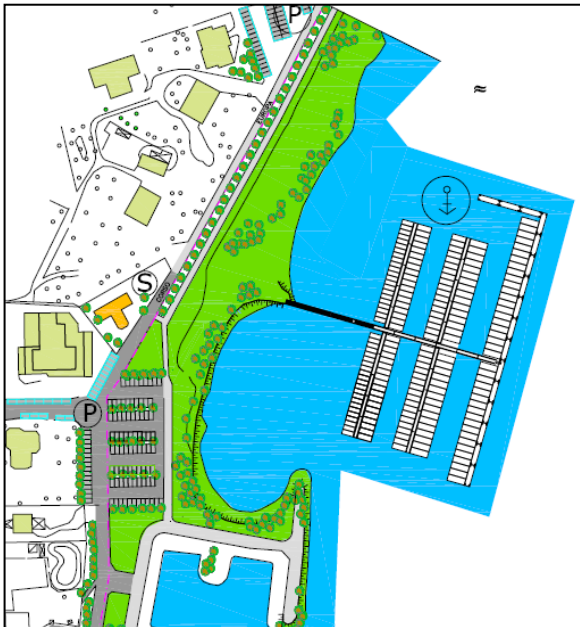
Progetto plani-volumetrico degli interventi previsti (allegato alla Variante n. 1 del Piano Particolareggiato “Litorale Sud” del Comune di Arona)
